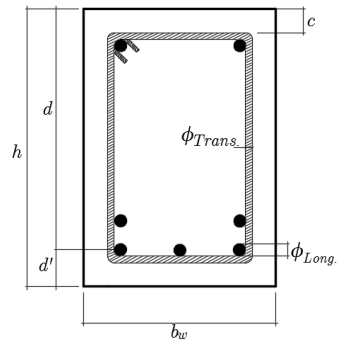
Seção Transversal de uma Viga Retangular de Concreto Armado
